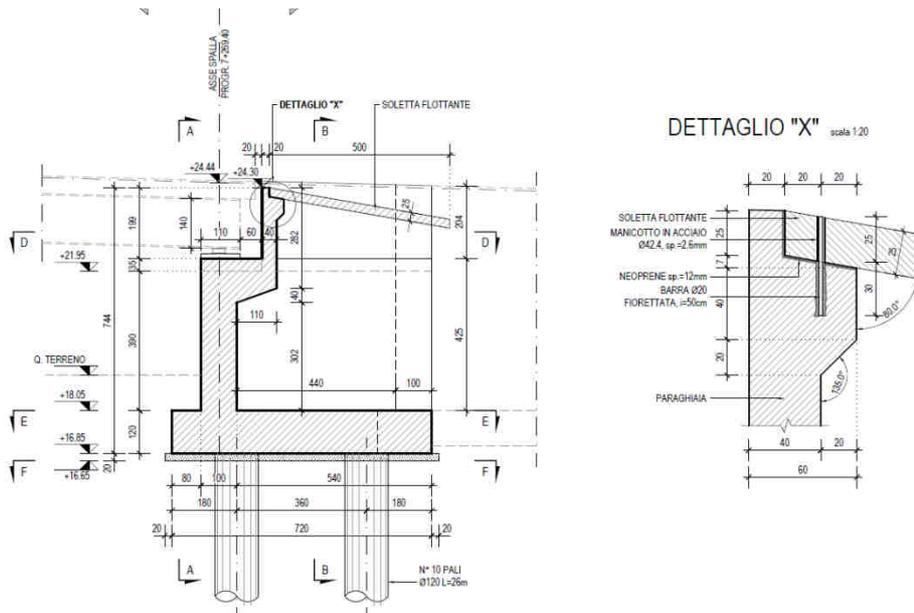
Prospetto spalla 2 e dettaglio soletta flottante – Viadotto Selargius Ovest
